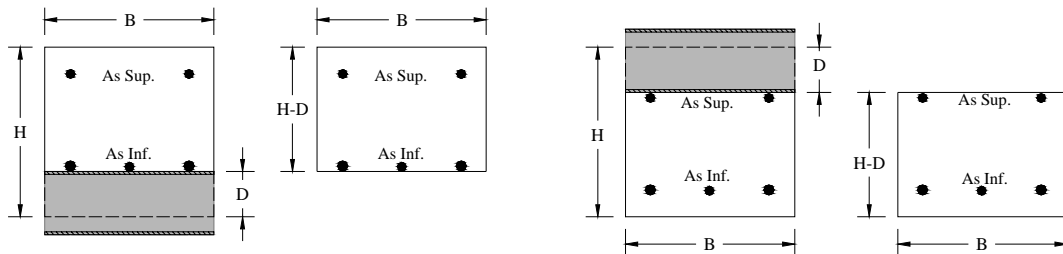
Consideraciones para la creación de secciones de vigas afectadas por una tubería horizontal en la parte inferior y superior del refuerzo, como secciones rectangulares en SAP-2000.
